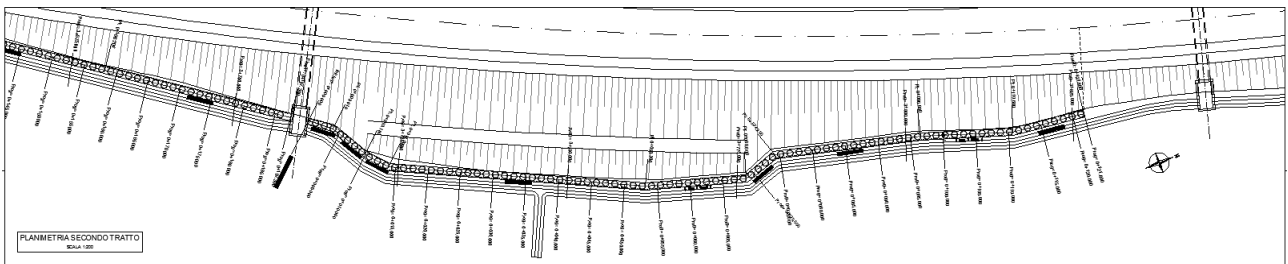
Opera di protezione del rilevato – planimetria secondo tratto
